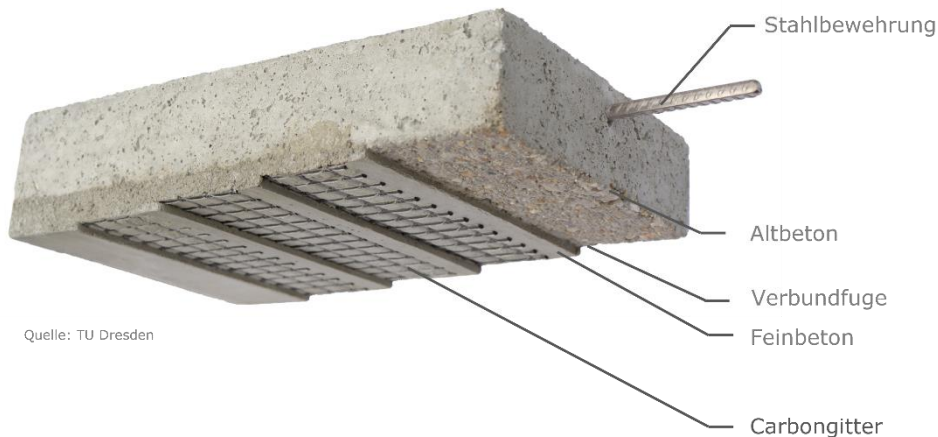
Verstärkung eines Stahlbetonbestandes mit Carbonbeton (Grafik: TU Dresden)
